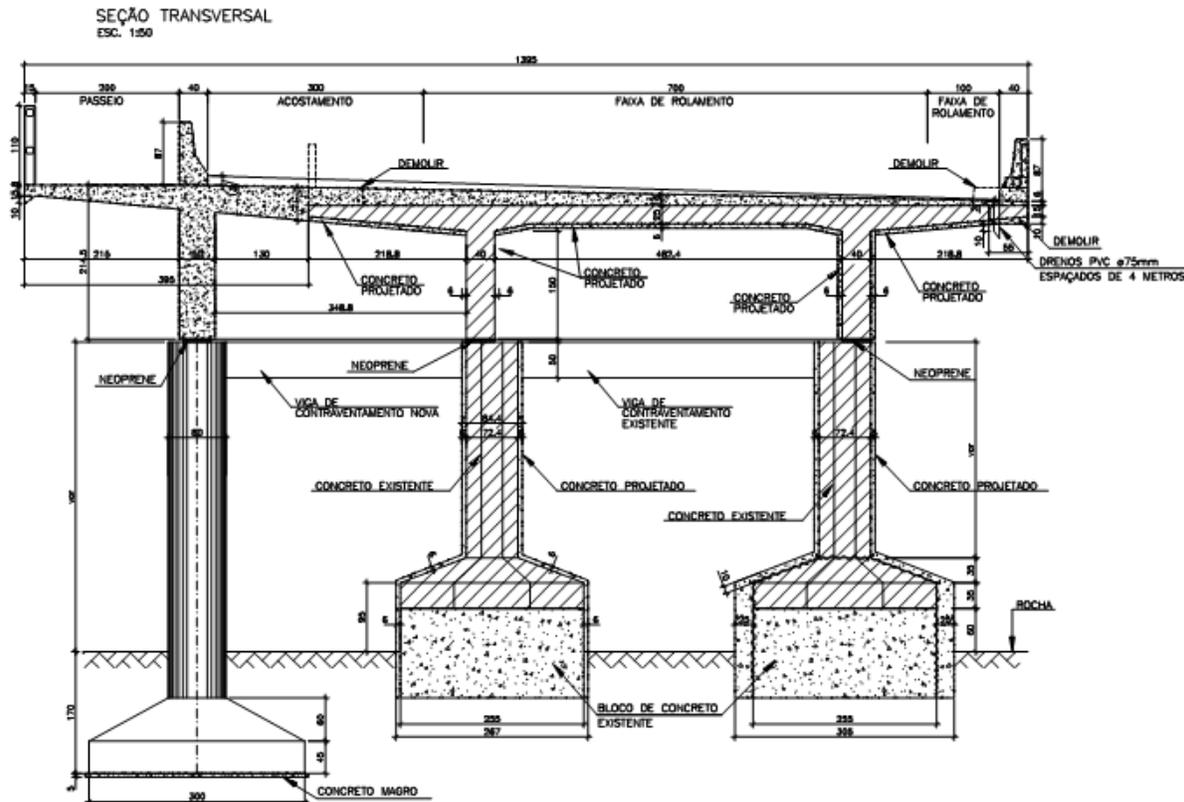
Seção transversal do alargamento de um dos lados do tabuleiro mostrando a nova fundação e o reforço das fundações existentes (VITÓRIO. (2014)).
